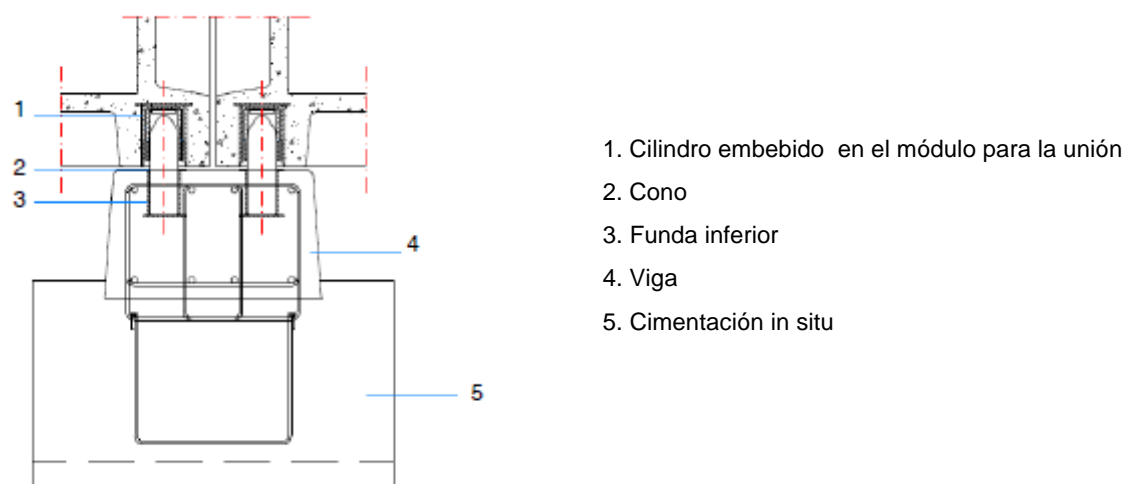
Detalle de la conexión entre la viga de cimentación Compact Habit® y la cimentación hecha in situ.
